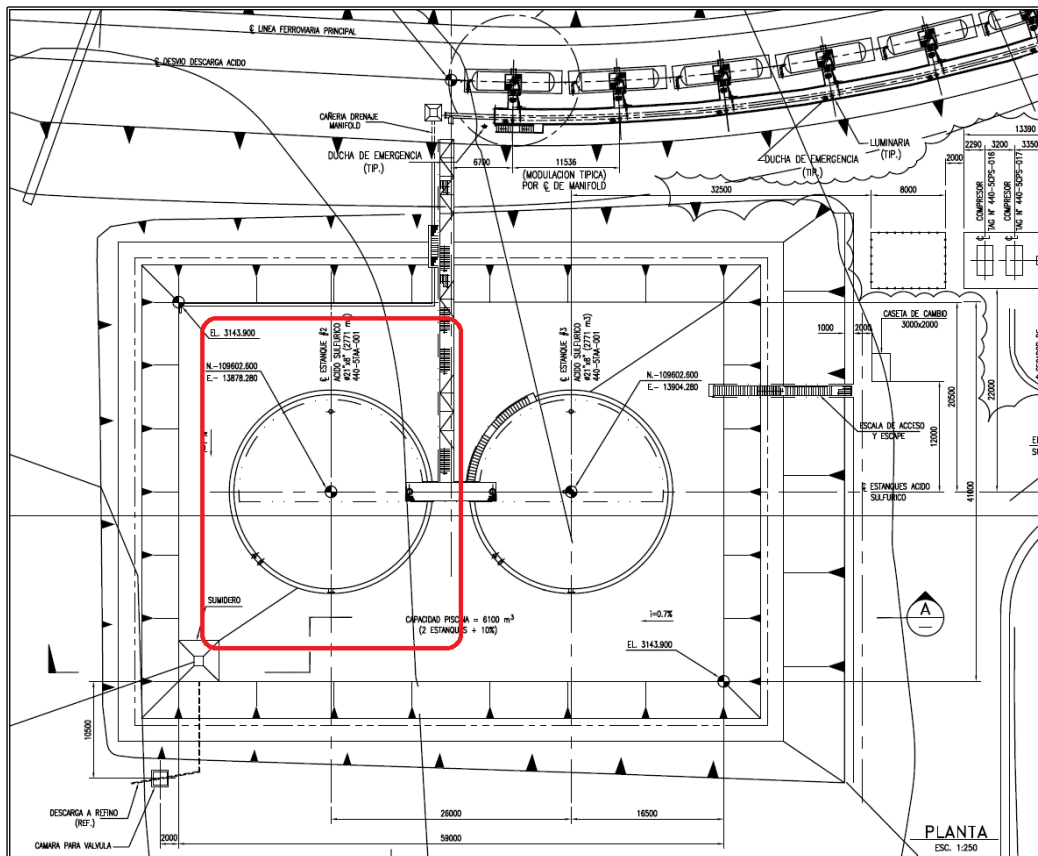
Vista de planta estanque de ácido TK-2, cátodos
